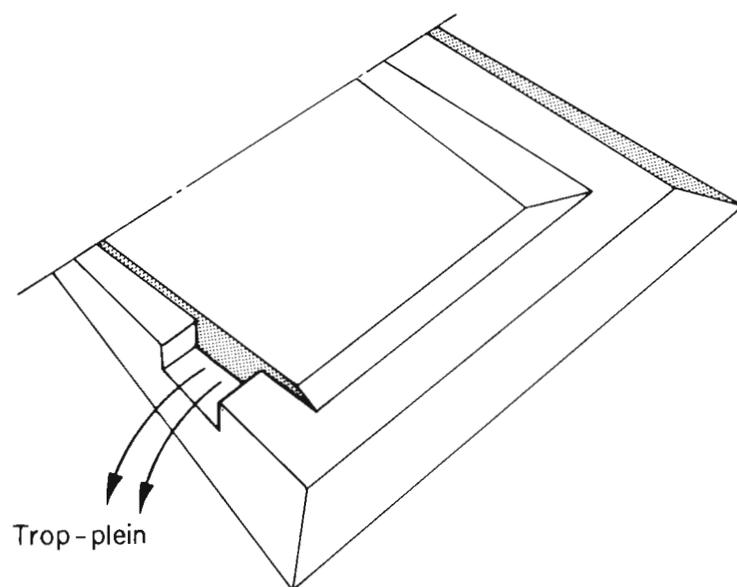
croquis d'une diguette construite suivant la courbe de niveau pour retenir à la fois le sol et l'eau (photo 4.11)
